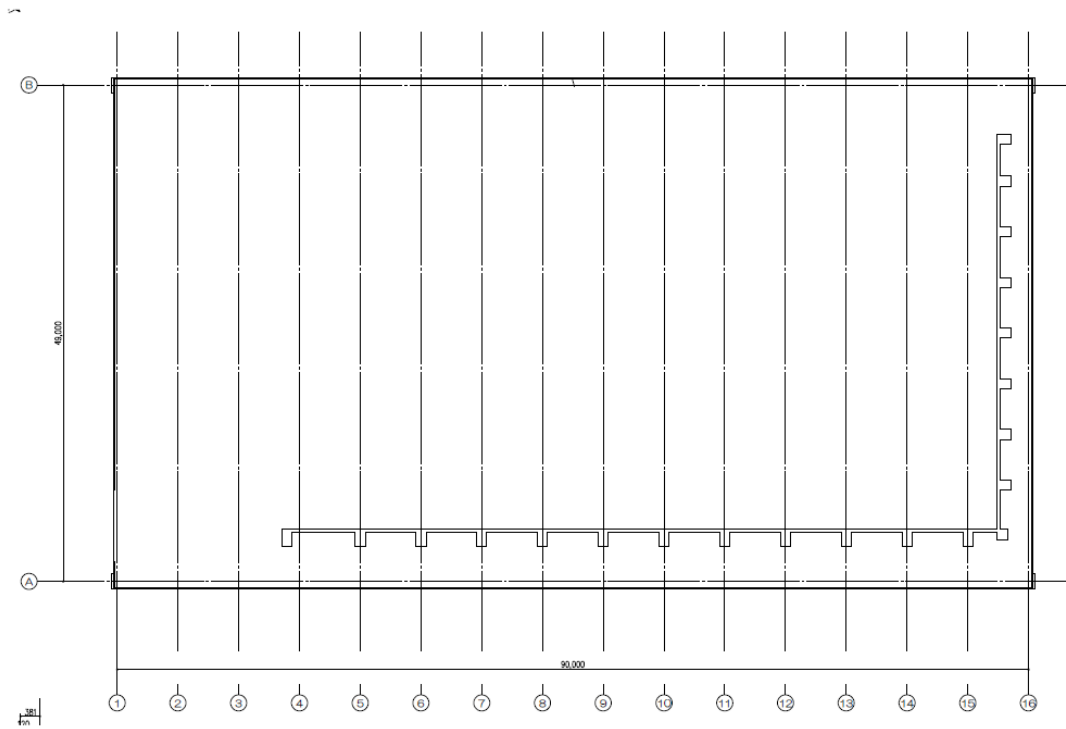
遮蔽壁の平面図 (10-A, B 貯蔵庫)
